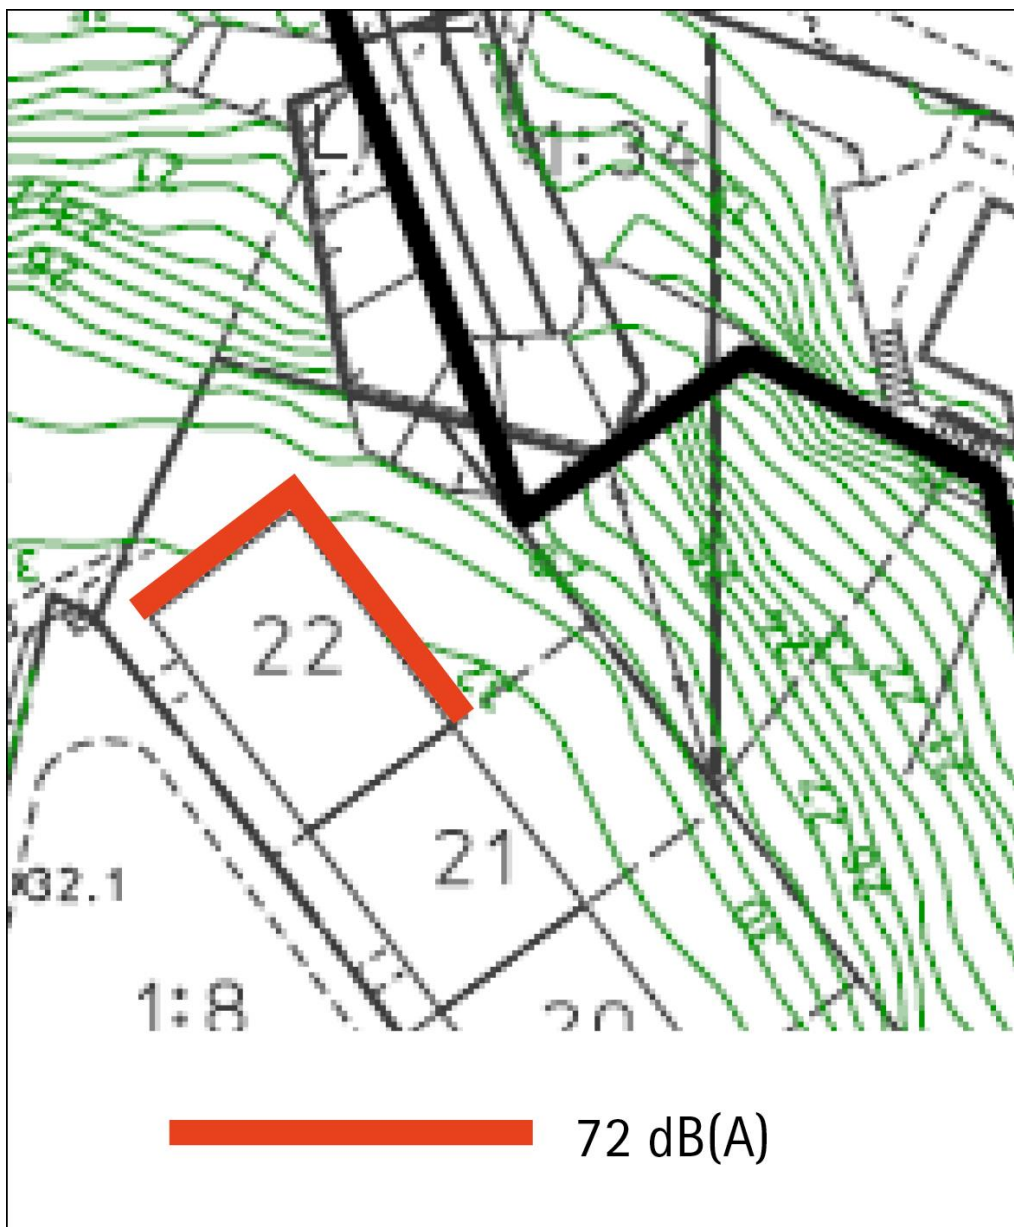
avser bullersituationen vid byggnad 22 före den planerade utbyggnaden enligt föreslagen detaljplan.
